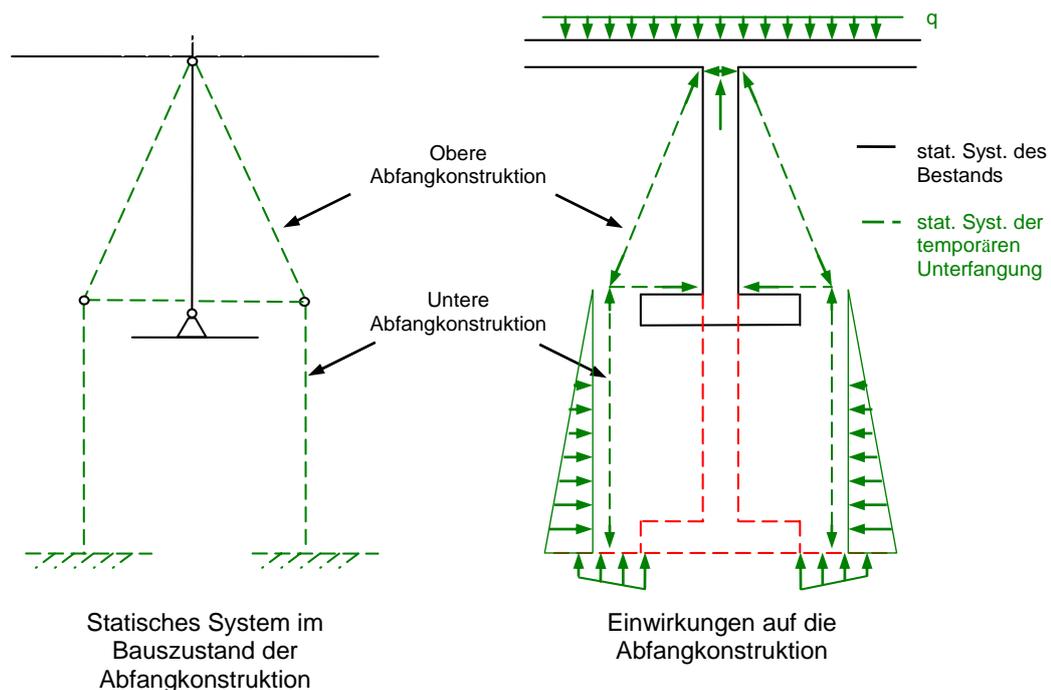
Statisches System der Abfangkonstruktion (aus den Anforderungen)
